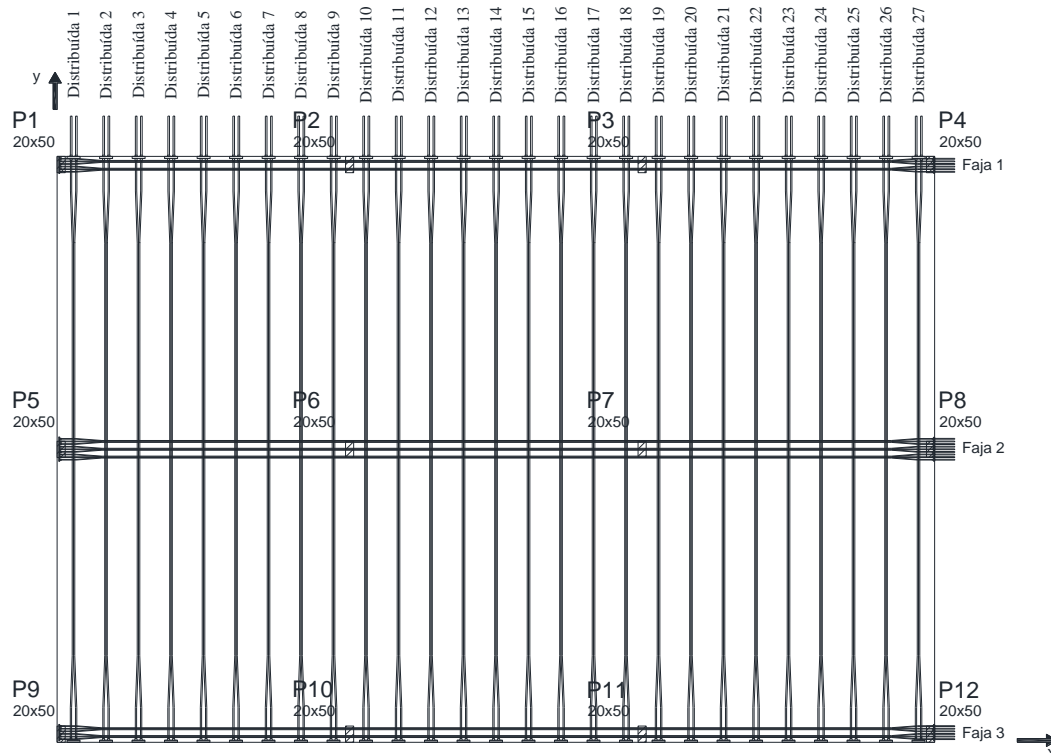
Layout de los tendones no-adherentes en la losa plana postensado.
